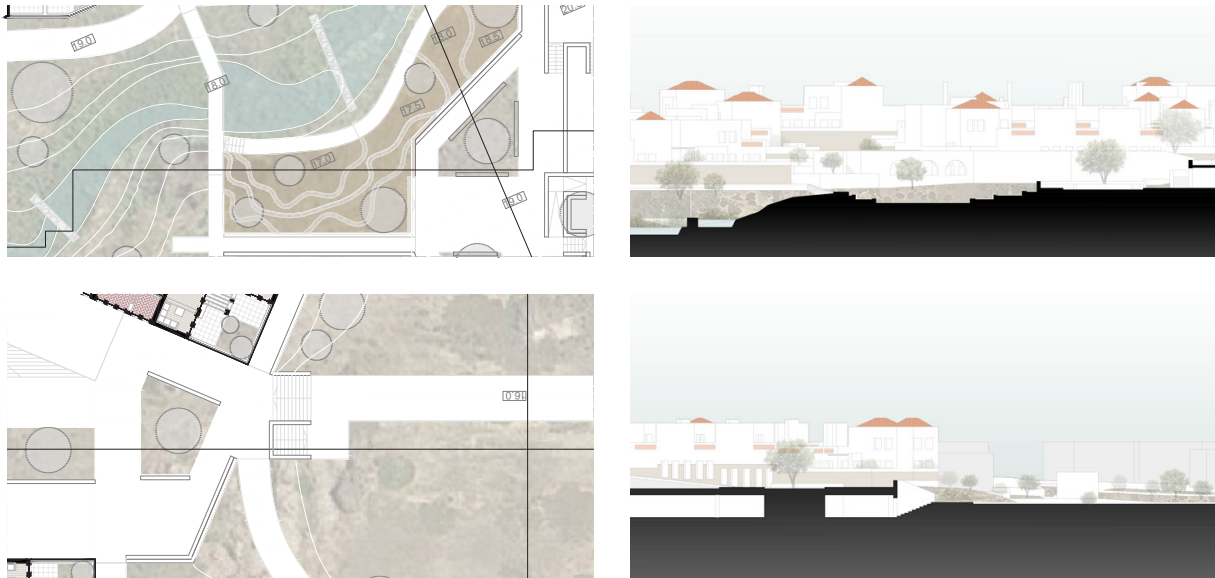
Planta e corte transição praças - espaço verde de recreio 1:1000
